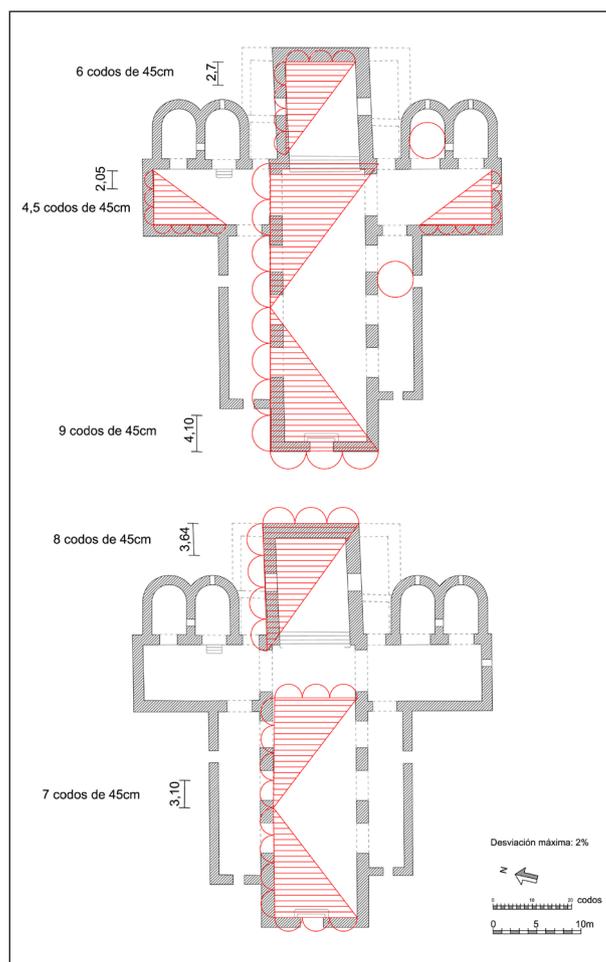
Planta de la fase del siglo X. Modulación de los espacios (planimetría de la autora).
